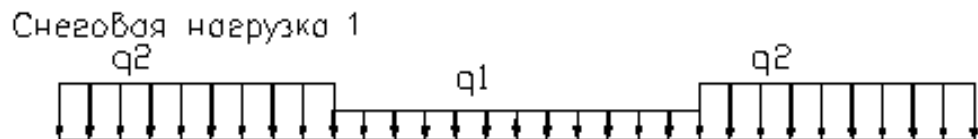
Загрузка снеговой нагрузки при опирании на ферму фонаря
